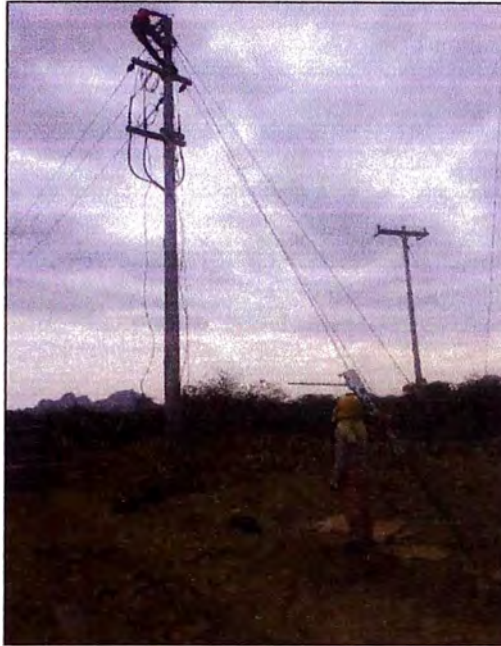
Instalación de accesorios de concreto. Fuente OPIC.
